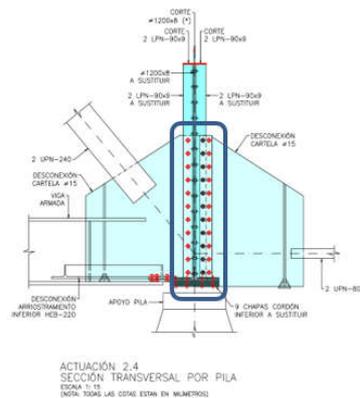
Nudo inferior mamparo de pila. Desatornillado de contraviento
